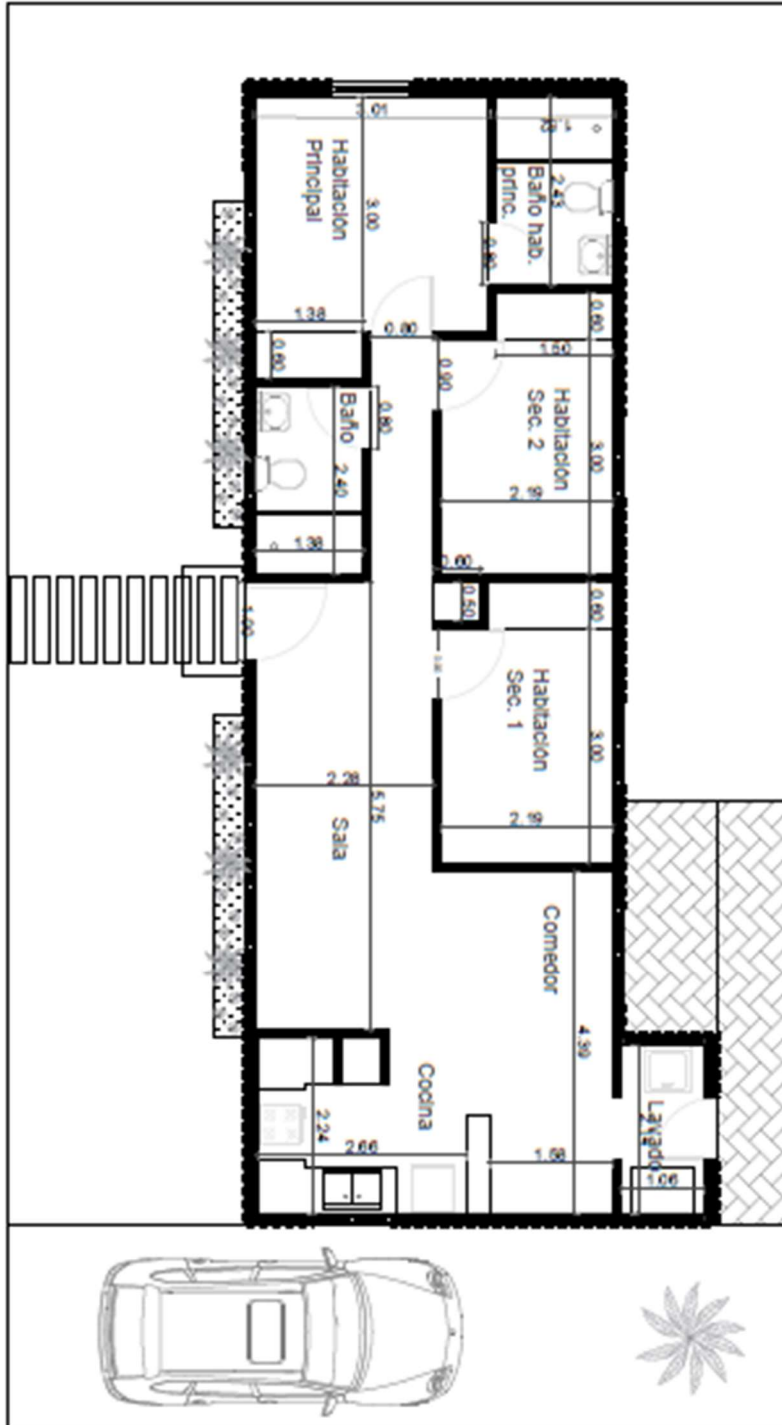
Diseño Arquitectónico – Planta de distribución interior dimensionada
